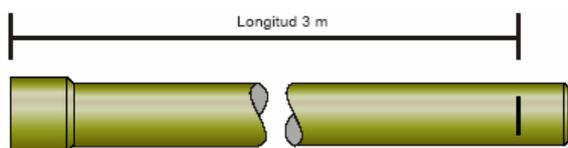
Tubo conduit de acero esmaltado pared delgada.
